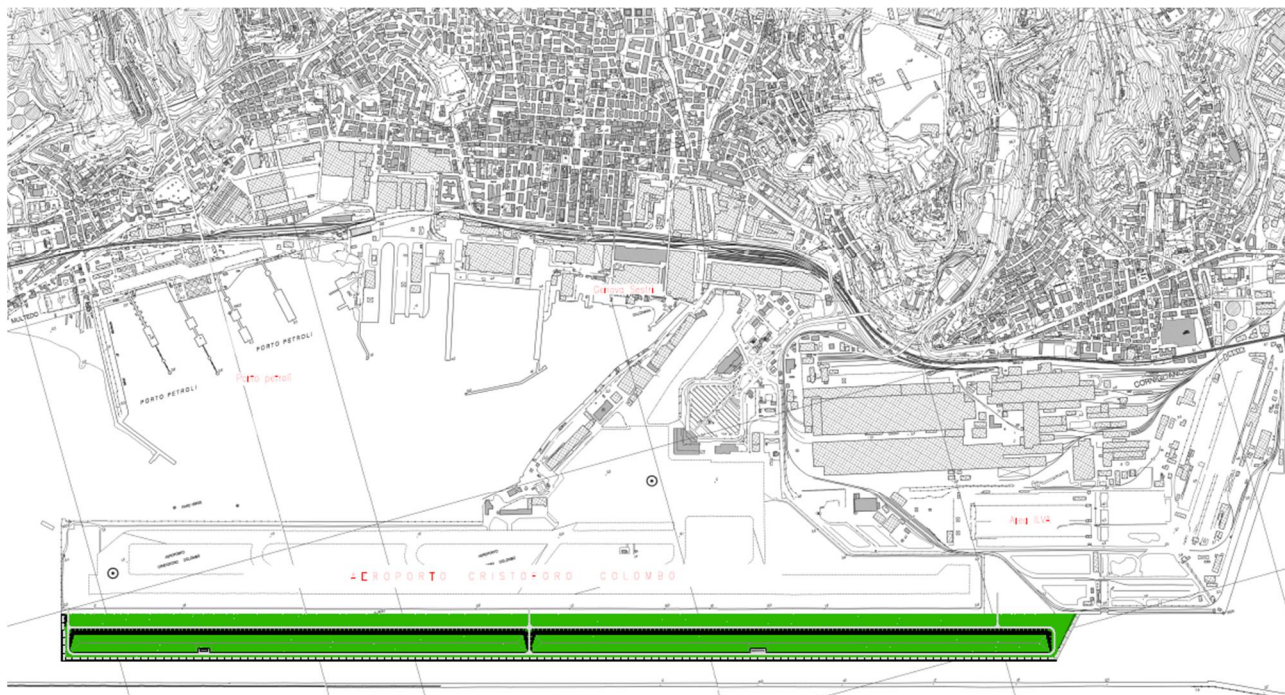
Planimetria generale (estratto da 110730-L10B-PE-DG-GEN-00000-00000-R-GEN0002-2)
